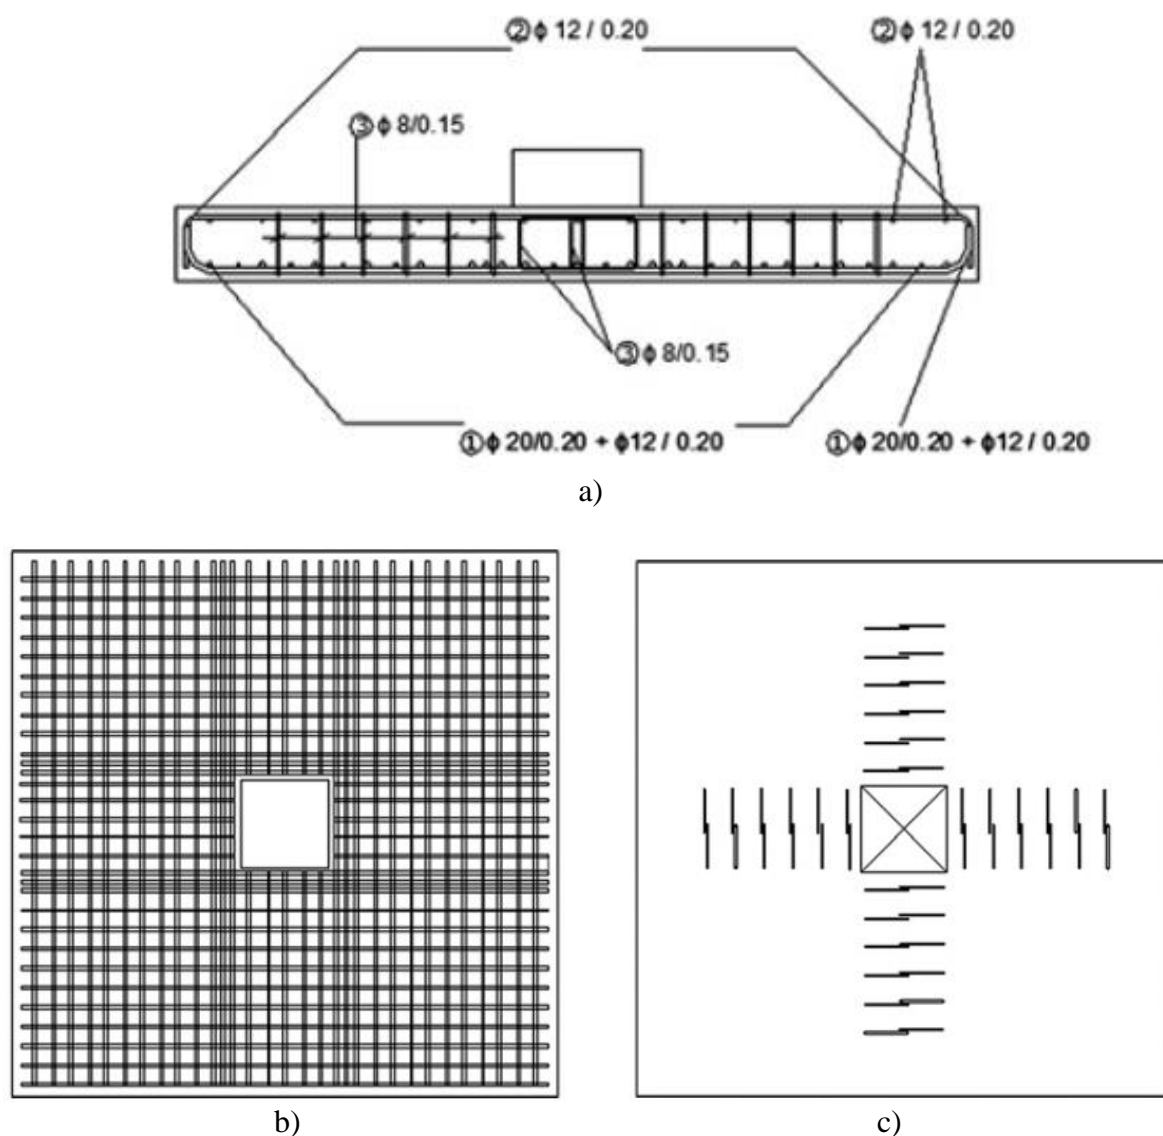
Detalhas das lajes 7 e 8 com estribos devidamente ancorados a) Disposição em corte; b) Vista mostrando a interrupção das armaduras de flexão no pilar; c) Detalhes da armadura de punção devidamente ancorados
